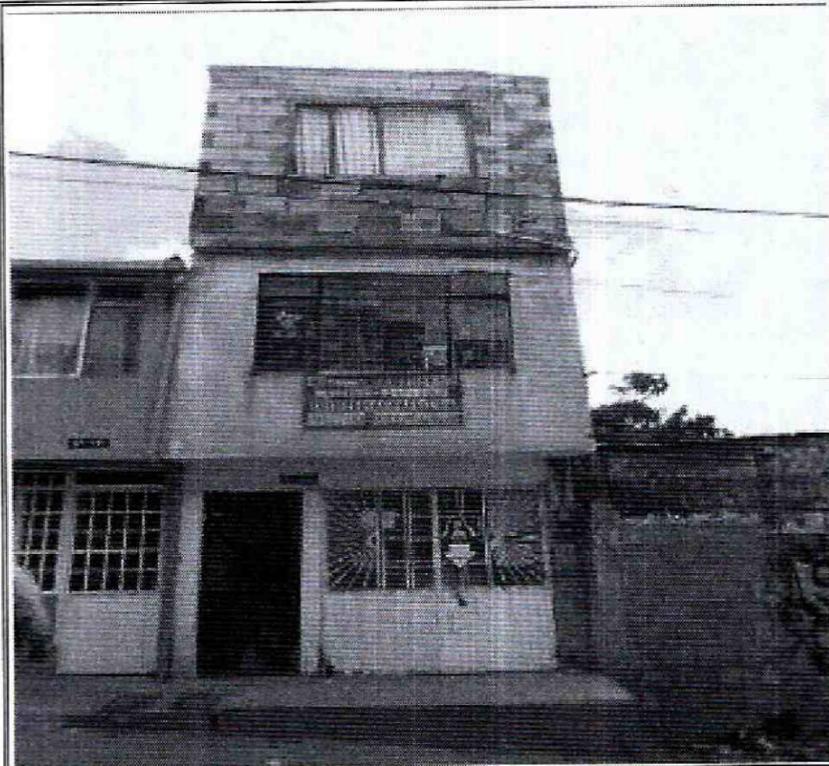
Vista frontal predio de la Calle 89 Bis Sur No. 8 D - 09 Este
